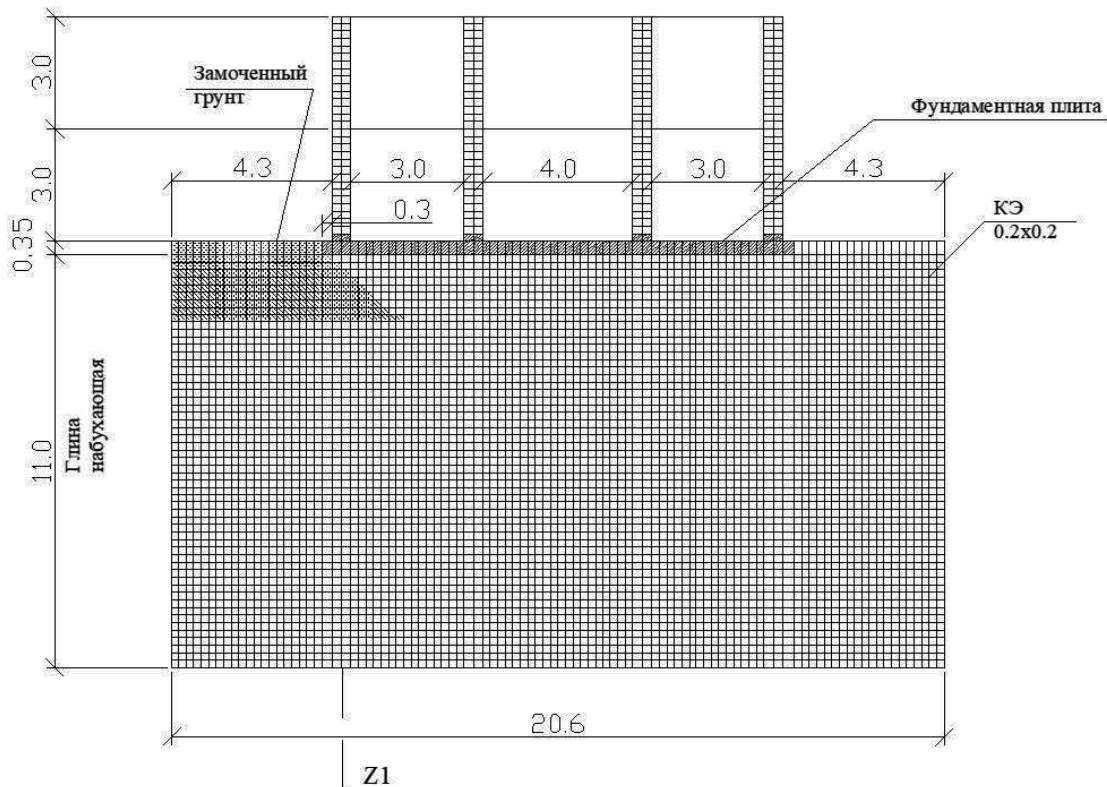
Расчетная схема двухэтажного кирпичного здания с фундаментом в виде плиты на однослойном основании
